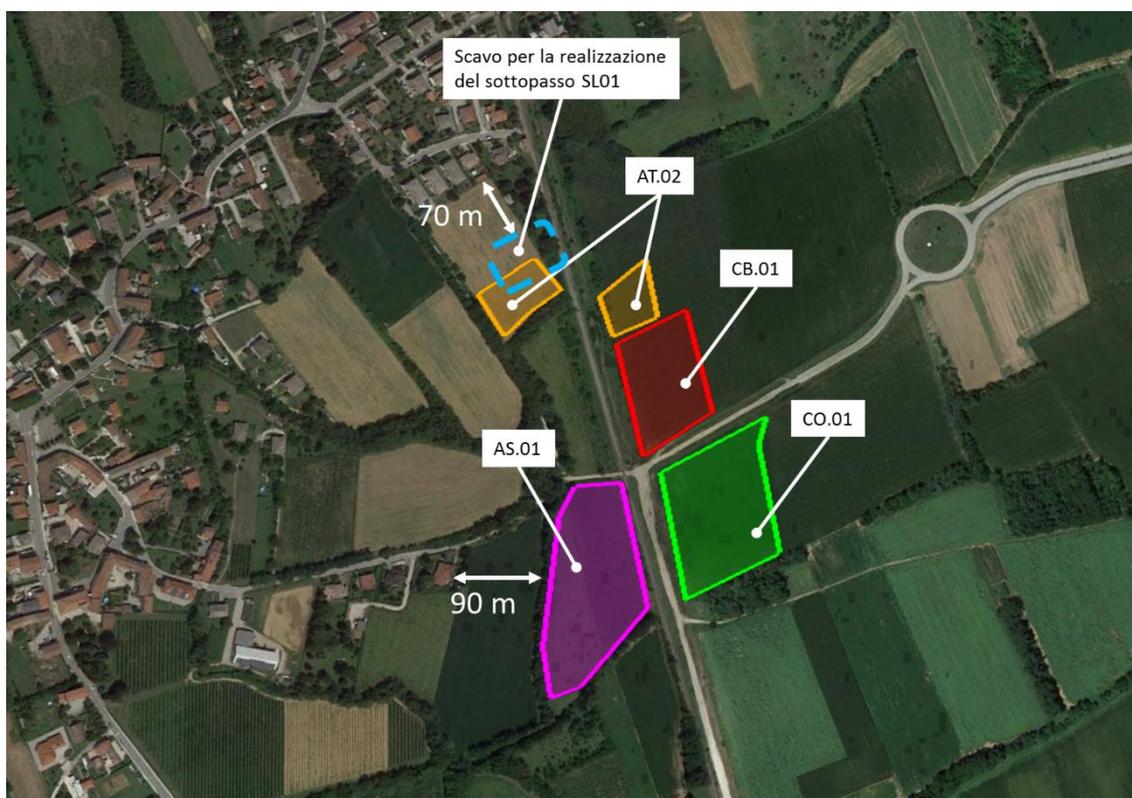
Localizzazione delle aree di cantiere e distanza minima dai recettori residenziali
